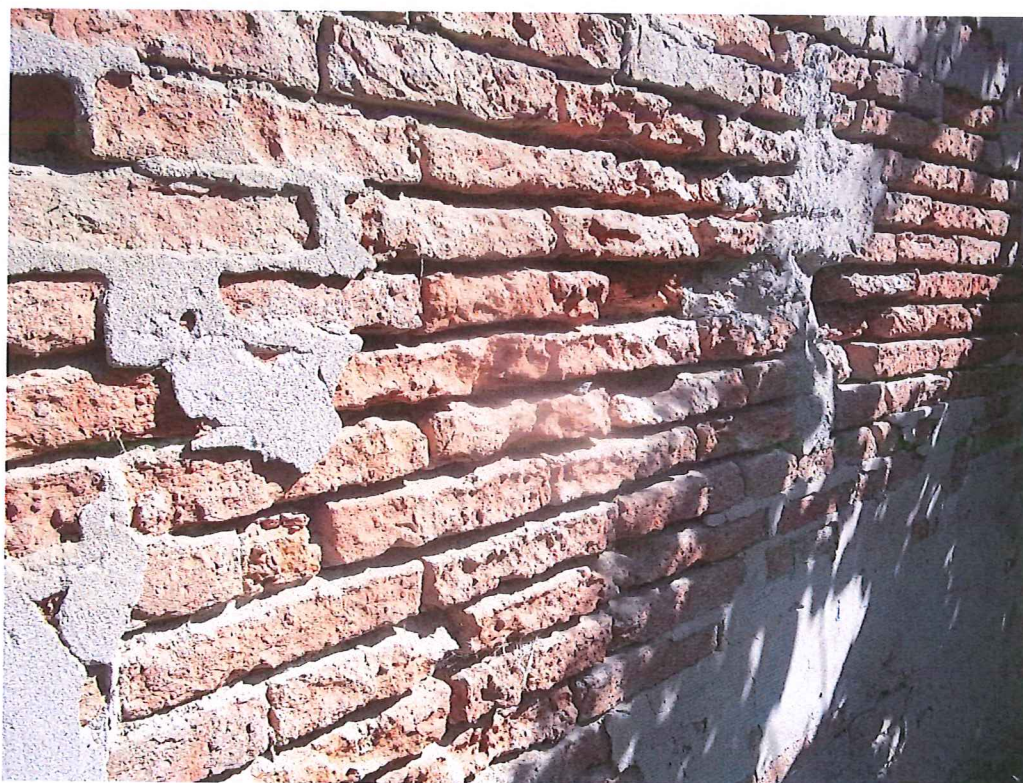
= Prospetto posteriore – Particolare qualità murature e malta
